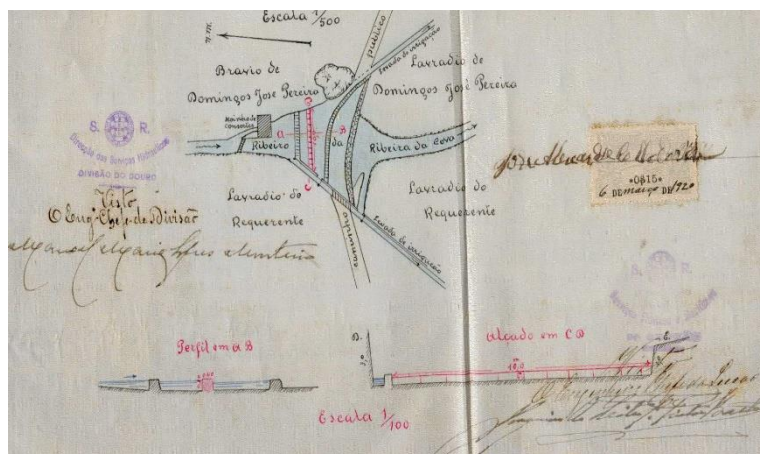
Planta e cortes relativos ao processo para a construção de açude para irrigação no ribeiro da Cova (Outeiro, Fonte Arcada, Póvoa de Lanhoso, 1920). Fonte: APA.
